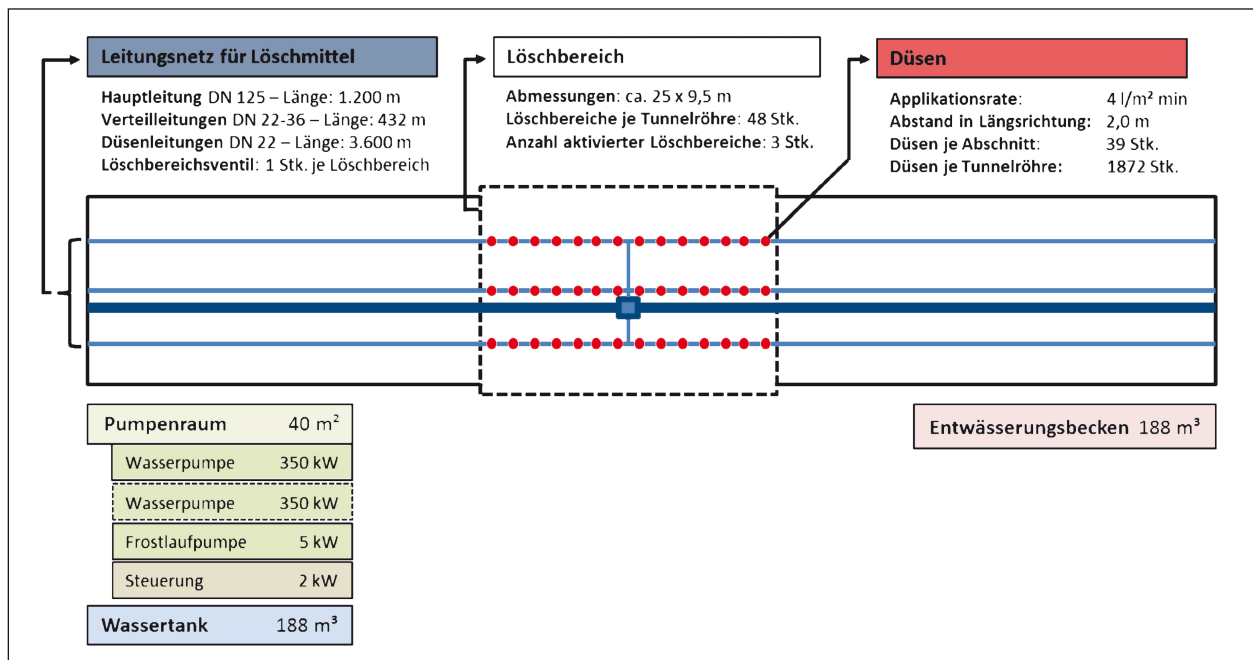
Tunneltyp 1 mit Konfiguration der Wassernebelanlage
